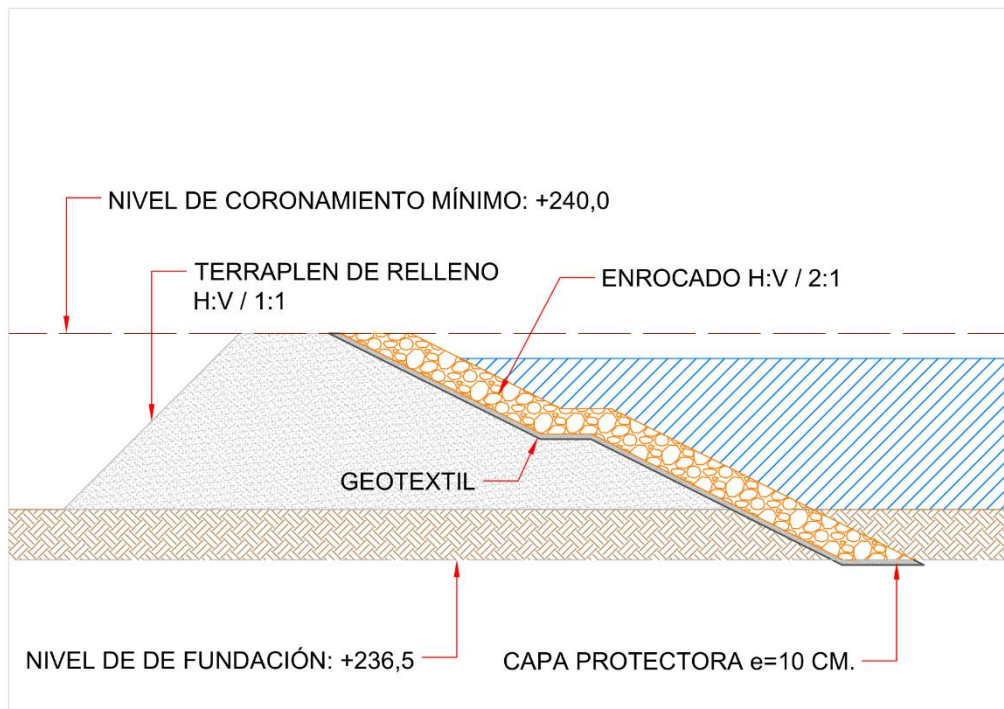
Corte transversal tipo para defensa de enrocados propuesta Acha Baja
